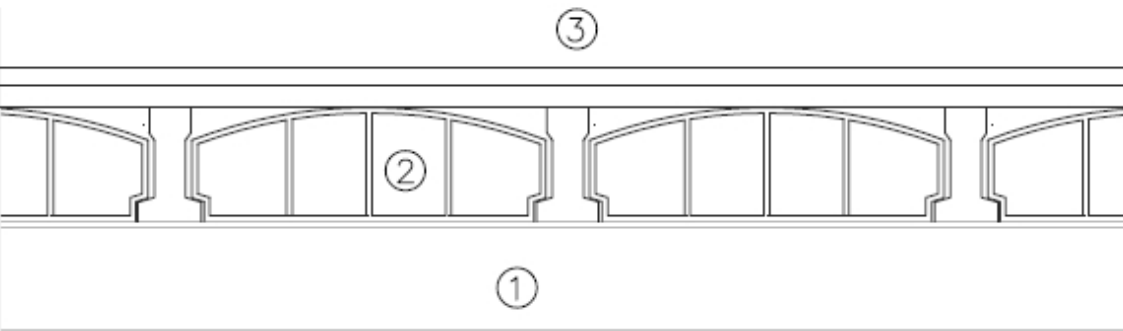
Detalle constructivo. Sección vertical de forjado intermedio. Elaboración propia.
